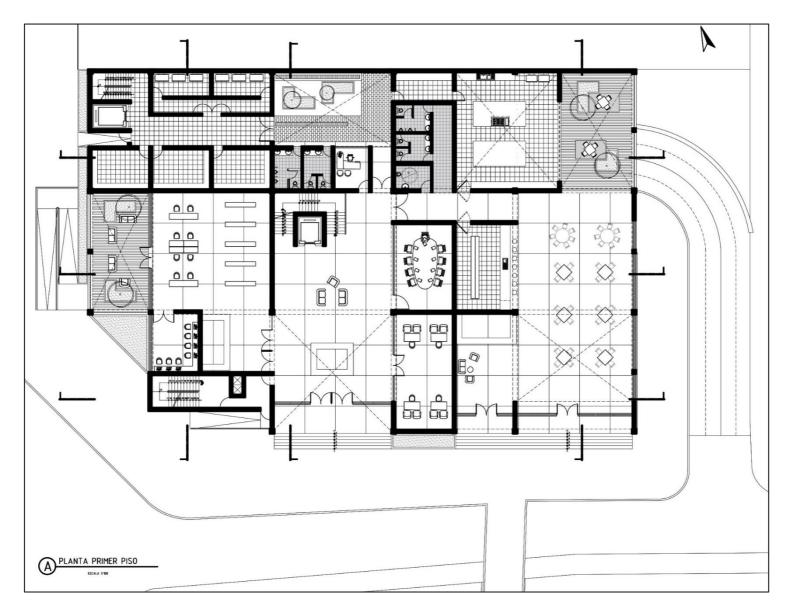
Planta de distribución - Primer Nivel Fuente: elaboración propia
